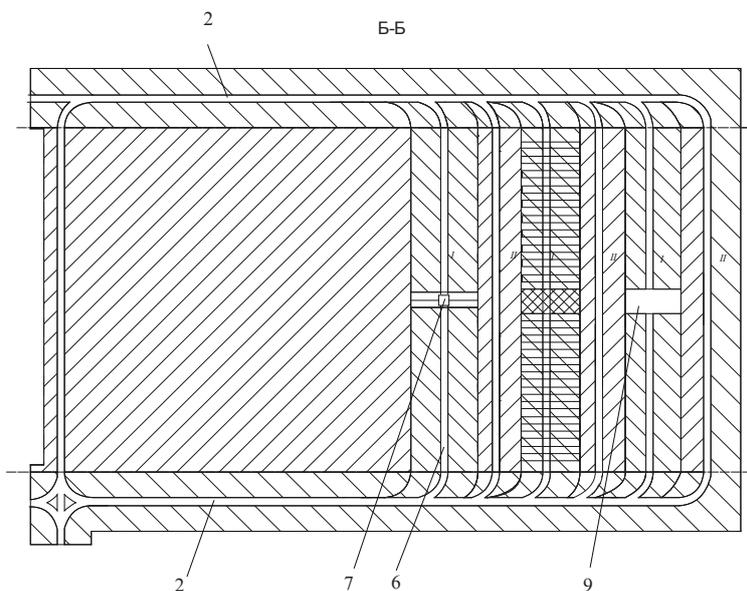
План вентиляционного горизонта (разрез Б-Б на рис. 1)
